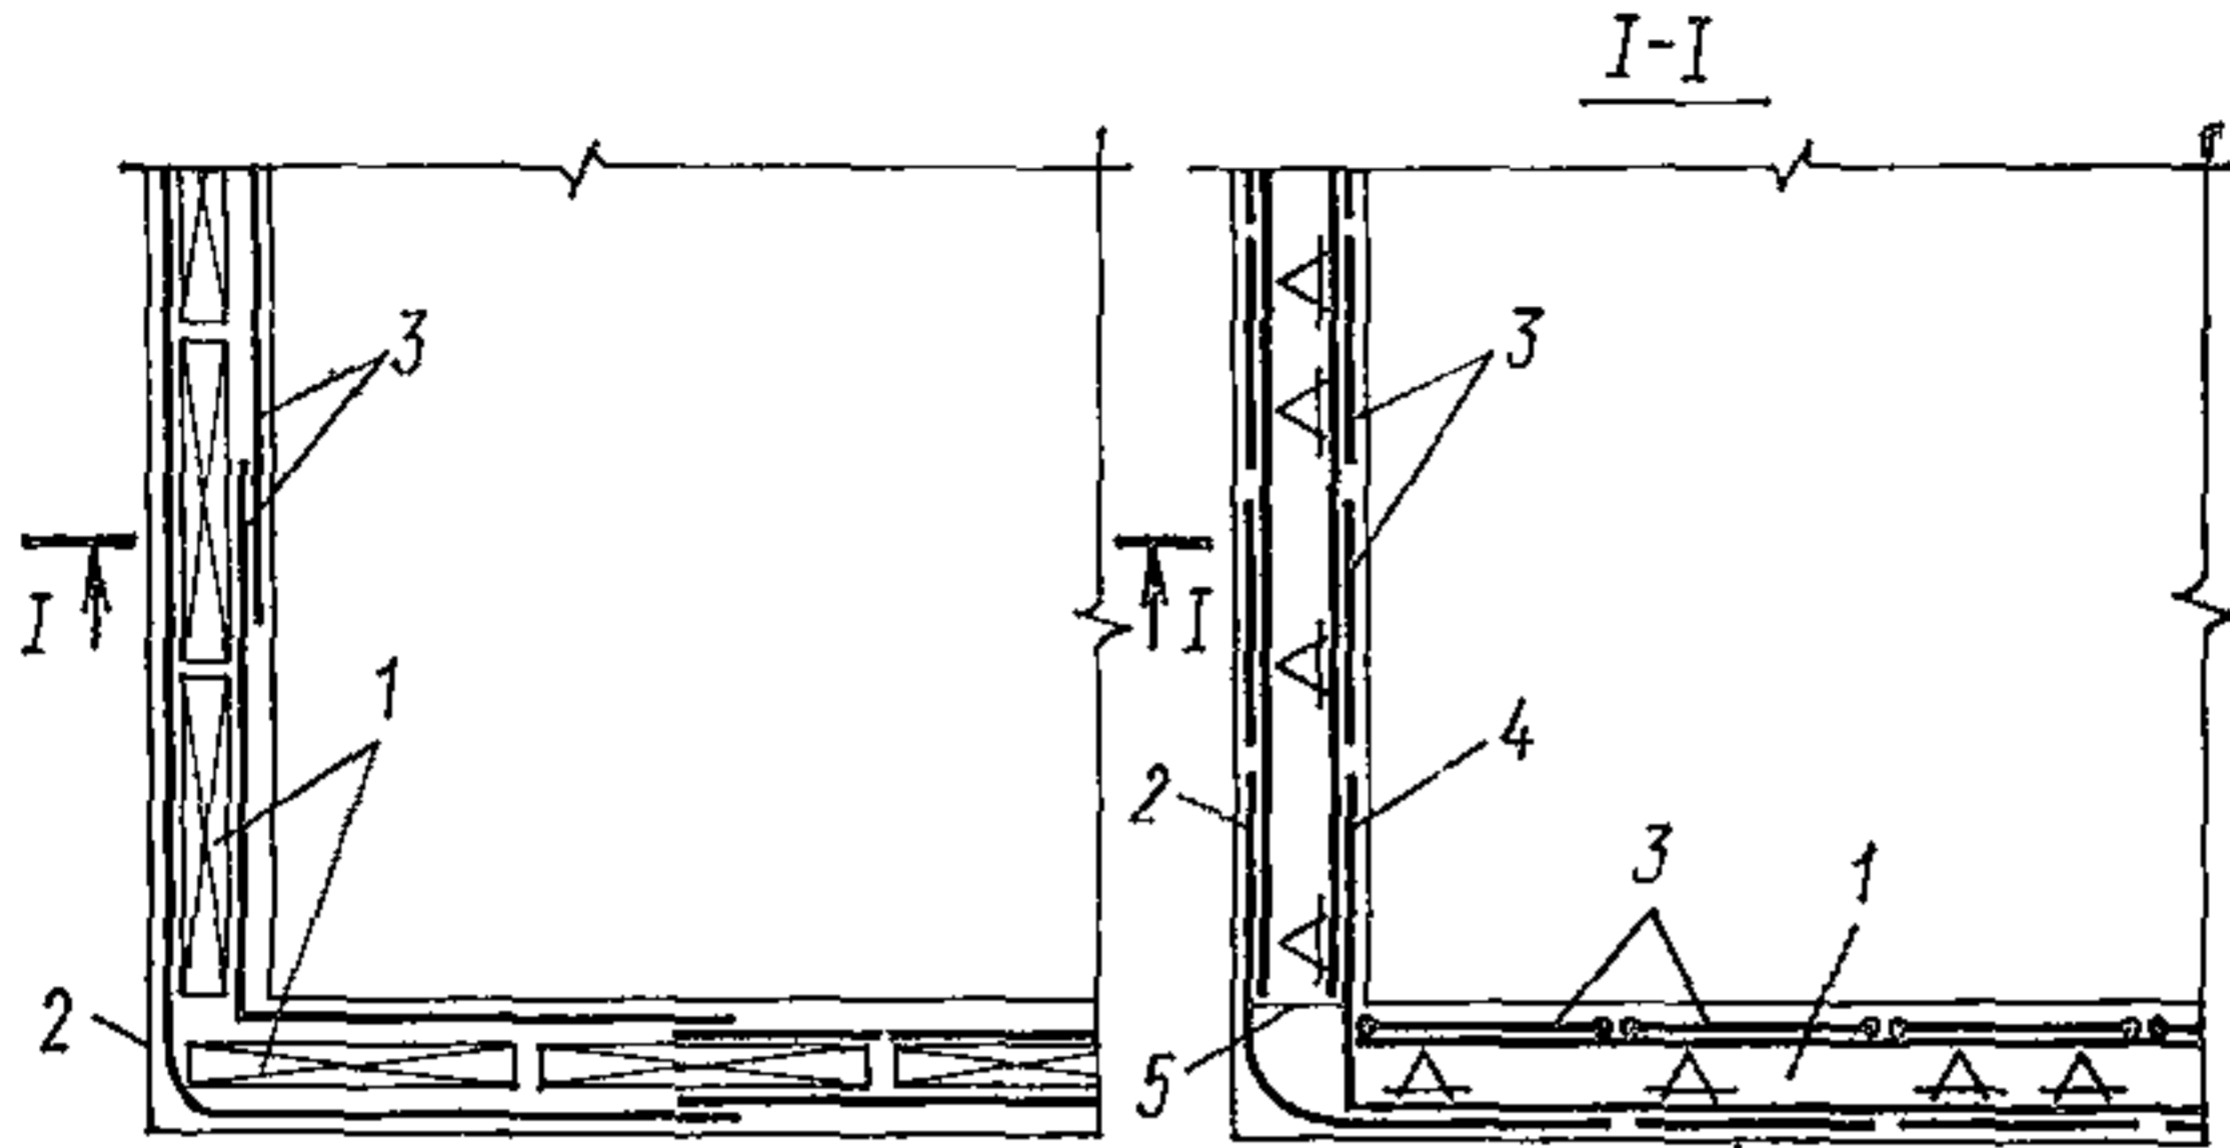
Армирование монолитных подвальных помещений армоблоками
